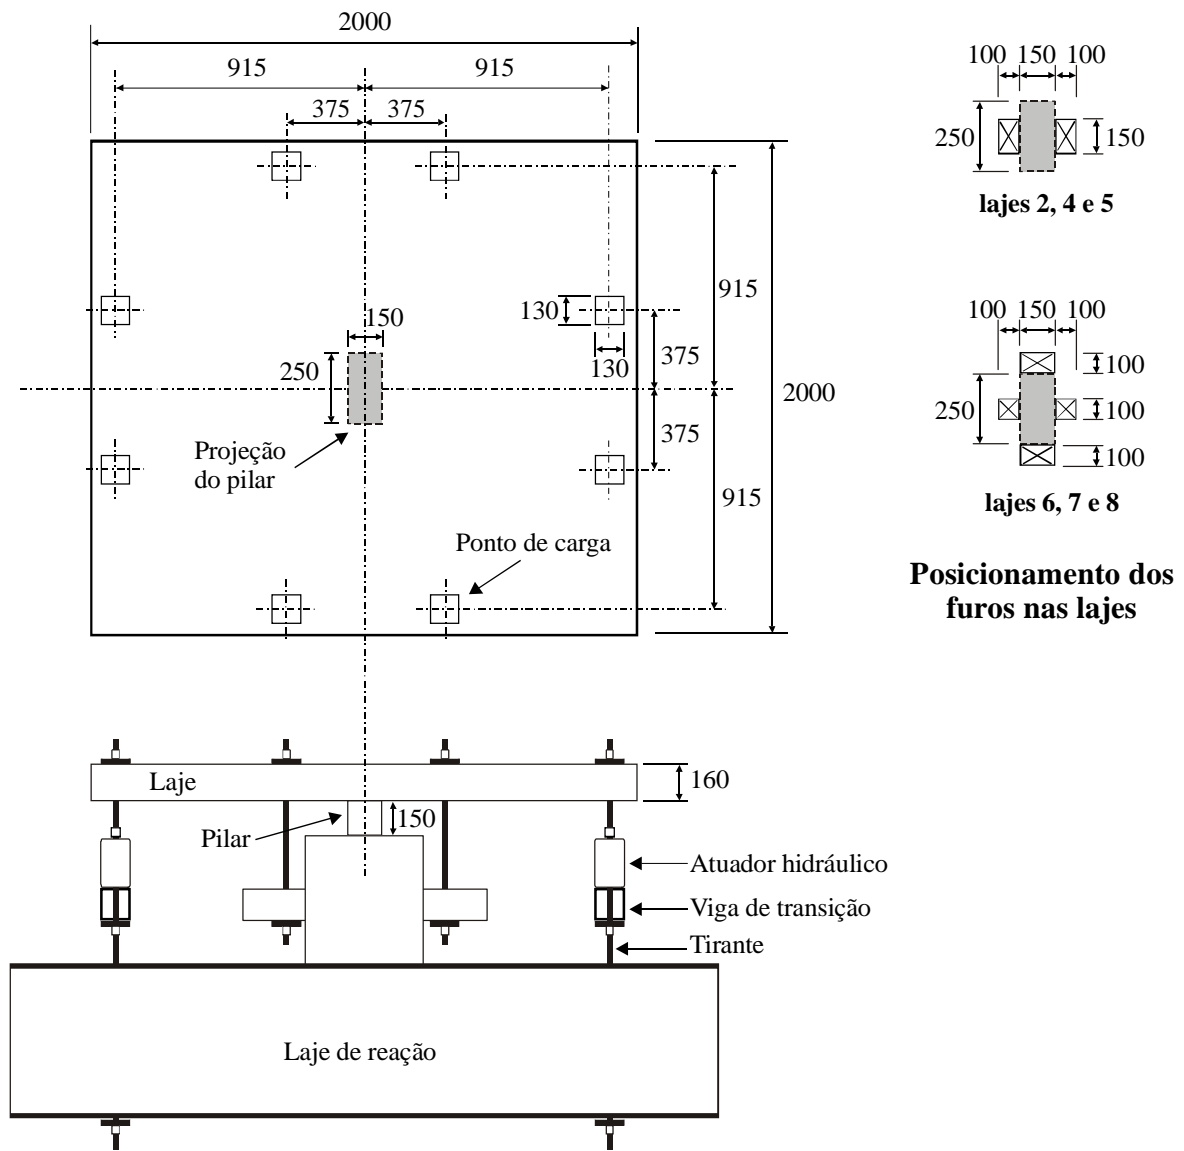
Esquema de aplicação de carga e posicionamento dos furos nas lajes testadas por REGAN (1999) (mm)
